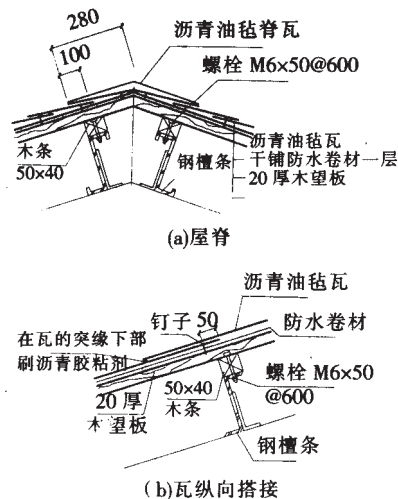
沥青瓦屋面构造(适用于“平改坡”旧屋面)
